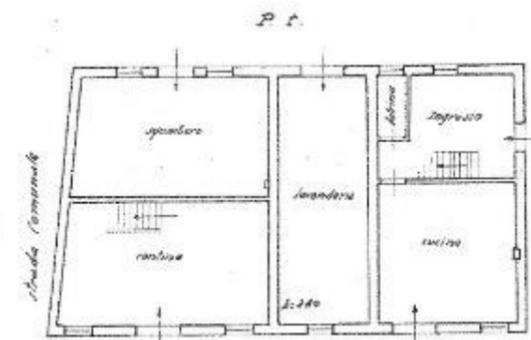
Fabbricato Principale. Planimetria Piano Terra
